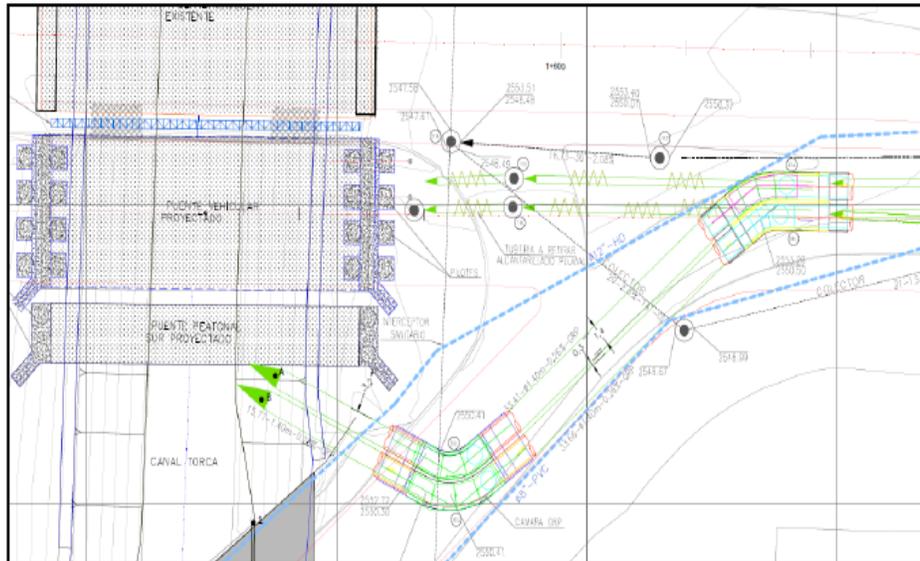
Ubicación general de la tubería existente y la nueva a construir en el sector oriental del canal Torca – Tubería 1.40 m.
